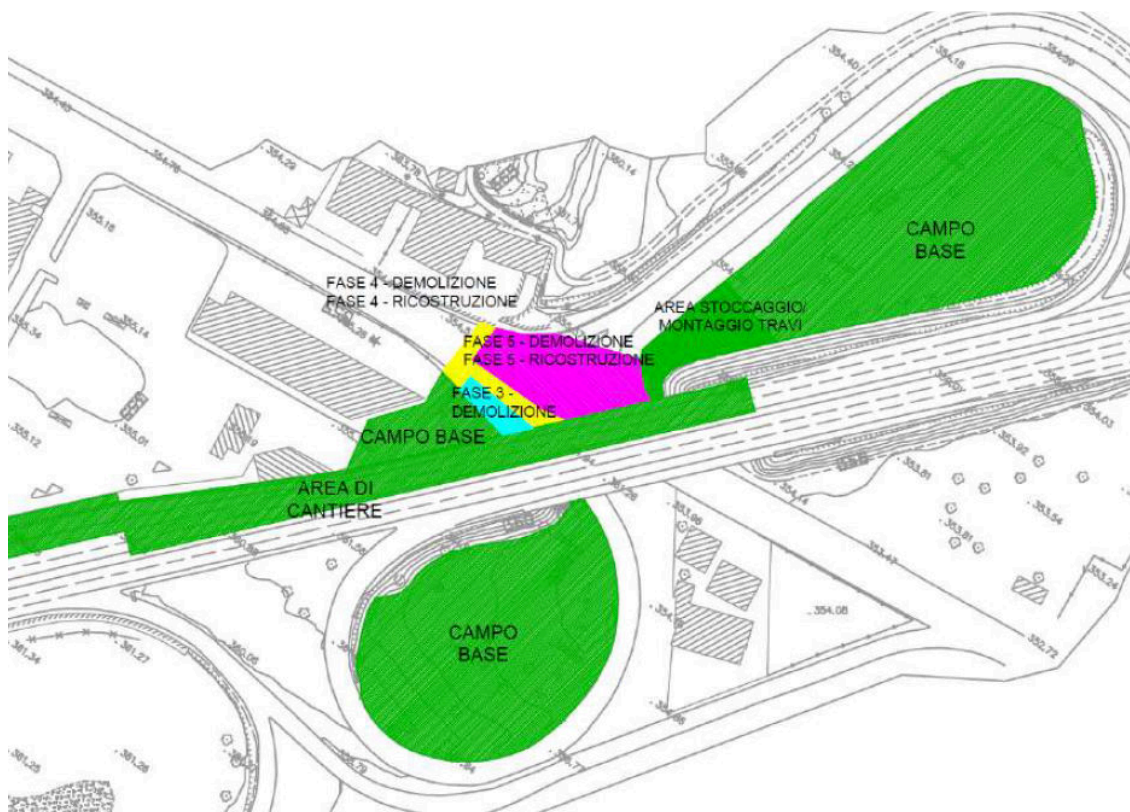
Planimetria di cantiere Fonte: Lista di controllo
